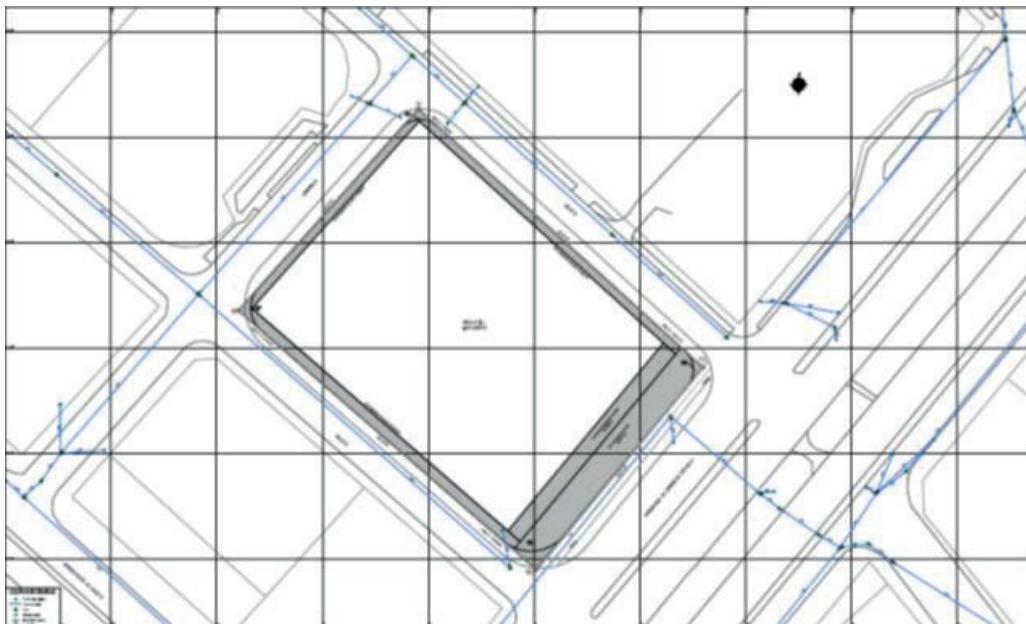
Redes existentes alcantarillado combinado en el área del Plan Parcial.
